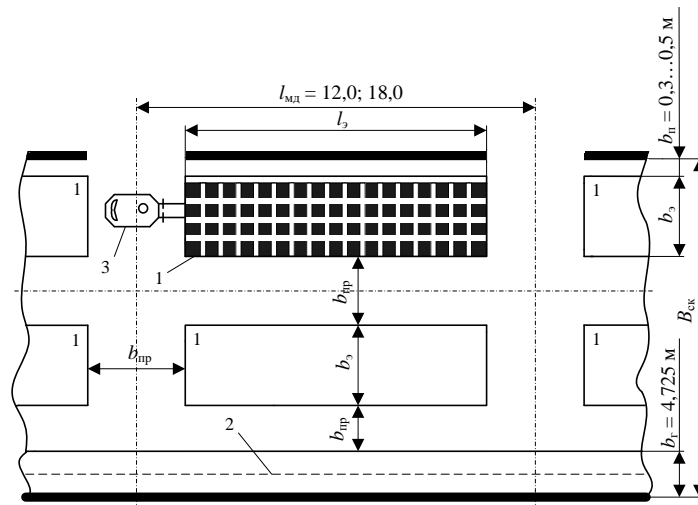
Схема к расчету параметров элементарной площадки:
